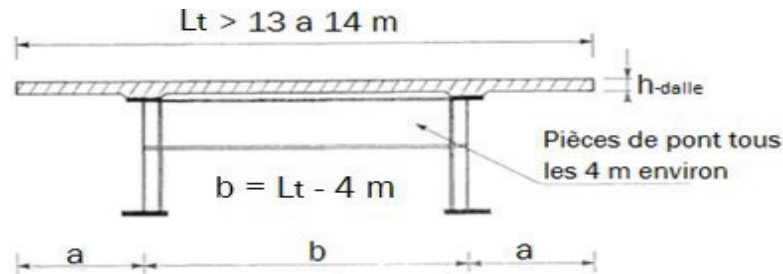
Coupe transversal d'un tablier bipoutre.
